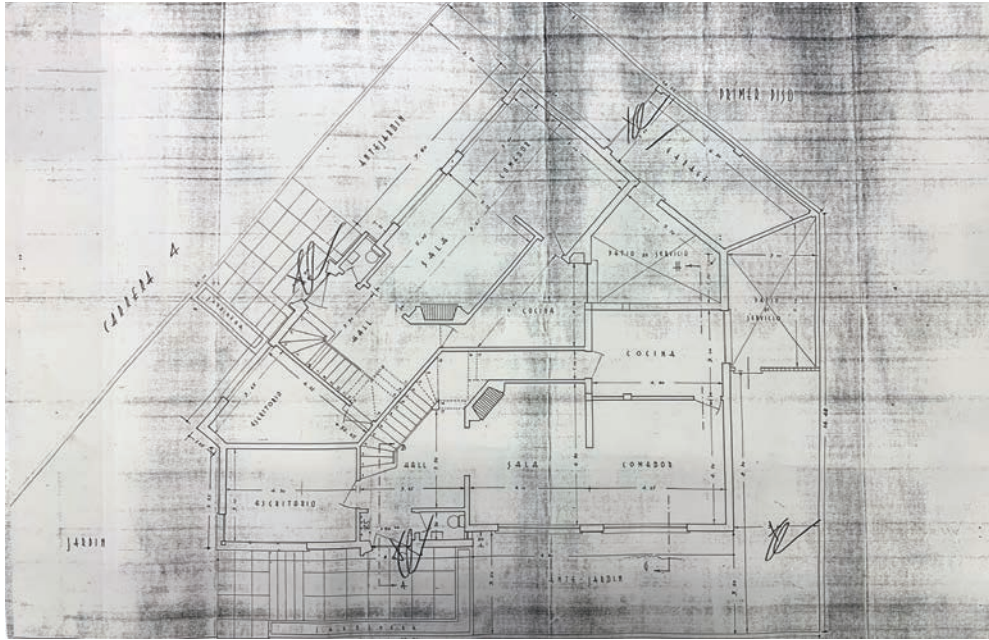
Casa Granés: planta baja (archivo Bermúdez) /
